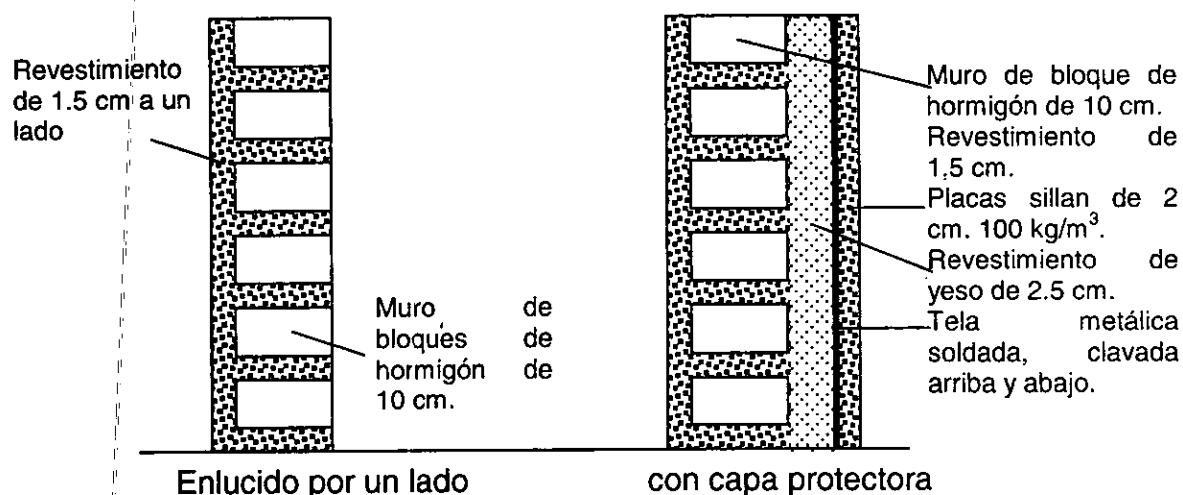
Aislamiento de un muro de bloques de hormigón y con revestimiento.
